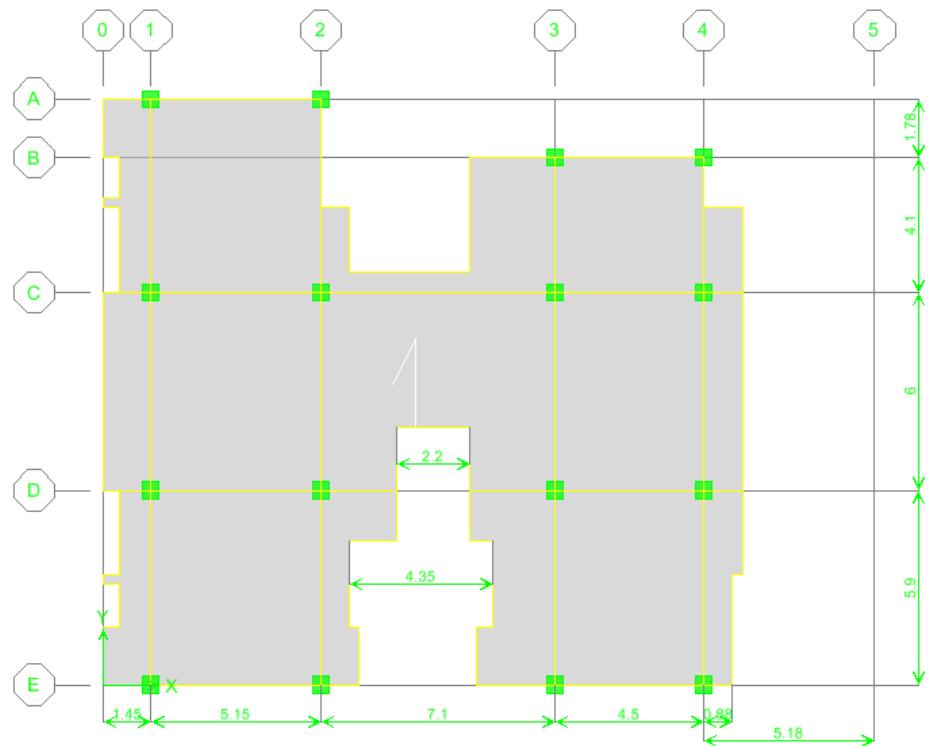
Planta piso Niveles +2.70, +5.40, +8.10, +10.80.
